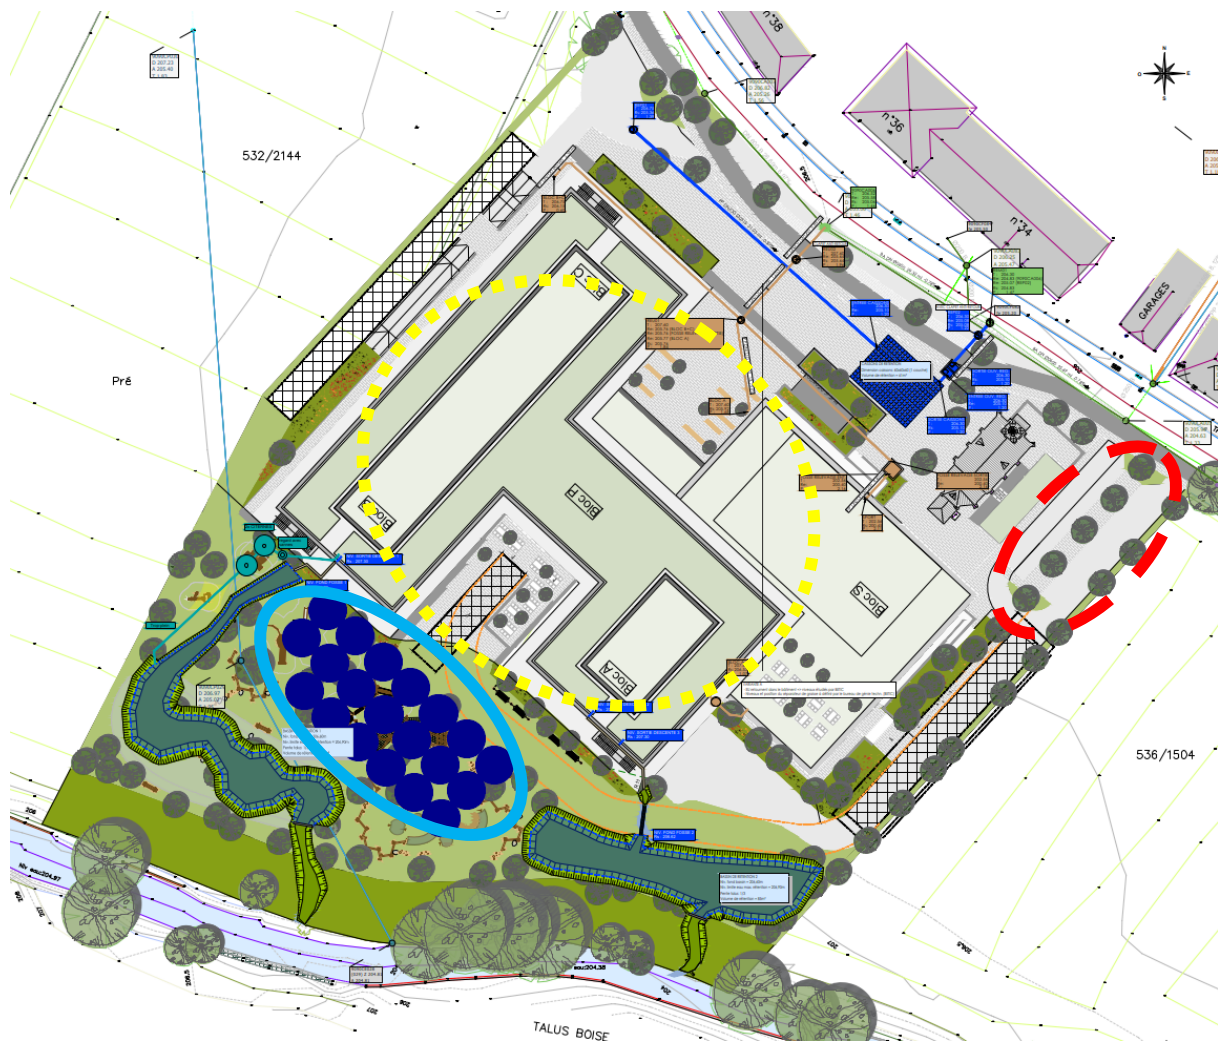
Planzone zum Schulareal. Der Bereich der Erdwärmebohrungen ist blau umkreist, während oberirdische Parkplätze rot (gestrichelt) und unterirdische Parkplätze gelb (gepunktet) angedeutet werden (Quelle: LUXPLAN S.A. / betic 2023).
